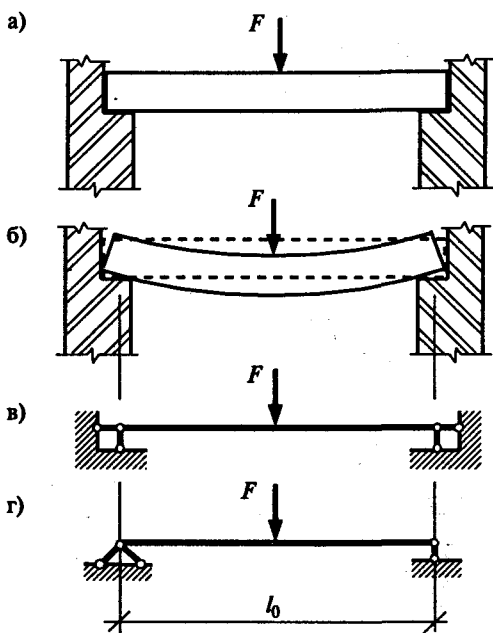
Вариант опирания балки на кирпичные стены:
